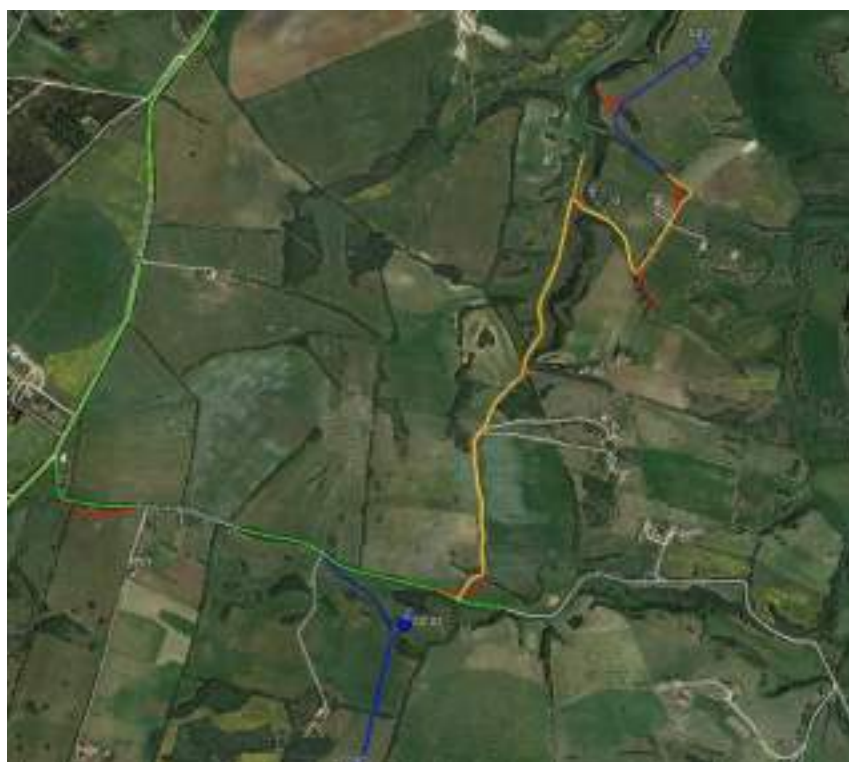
Individuazione viabilità interna su Aerofotogrammetria - INGRESSO 1 WTGs SS01, SS02 e SS03
